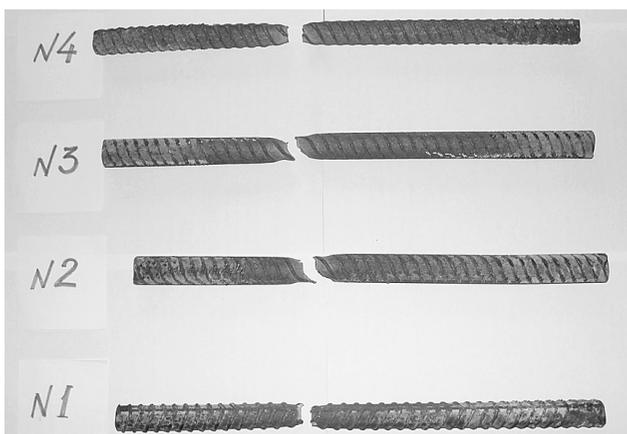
Образцы арматуры А-IIIв из продольных ребер плит после испытания
